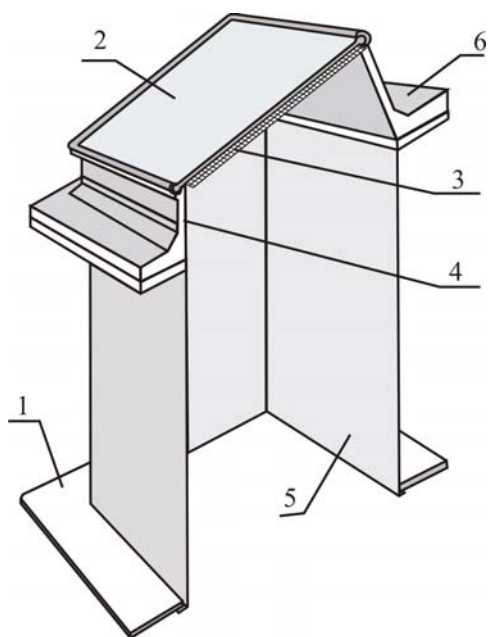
Зенитный фонарь со светопроводной шахтой: 1 – подвесной потолок; 2 – светопропускающее заполнение; 3 – защитная сетка; 4 – опорный контур; 5 – светопроводная шахта; 6 – кровля
